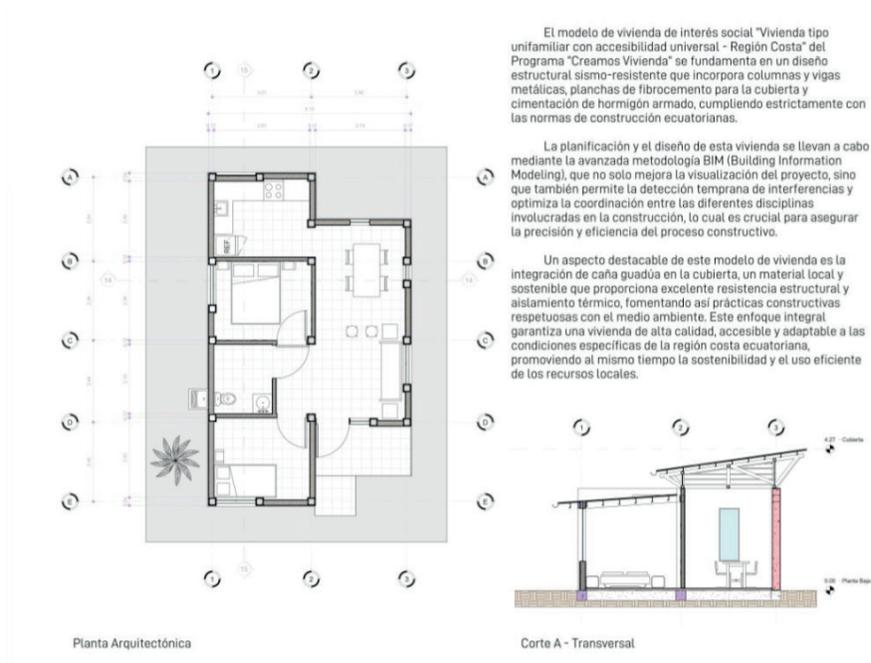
Planta arquitectónica y sección de vivienda unifamiliar de accesibilidad universal.
